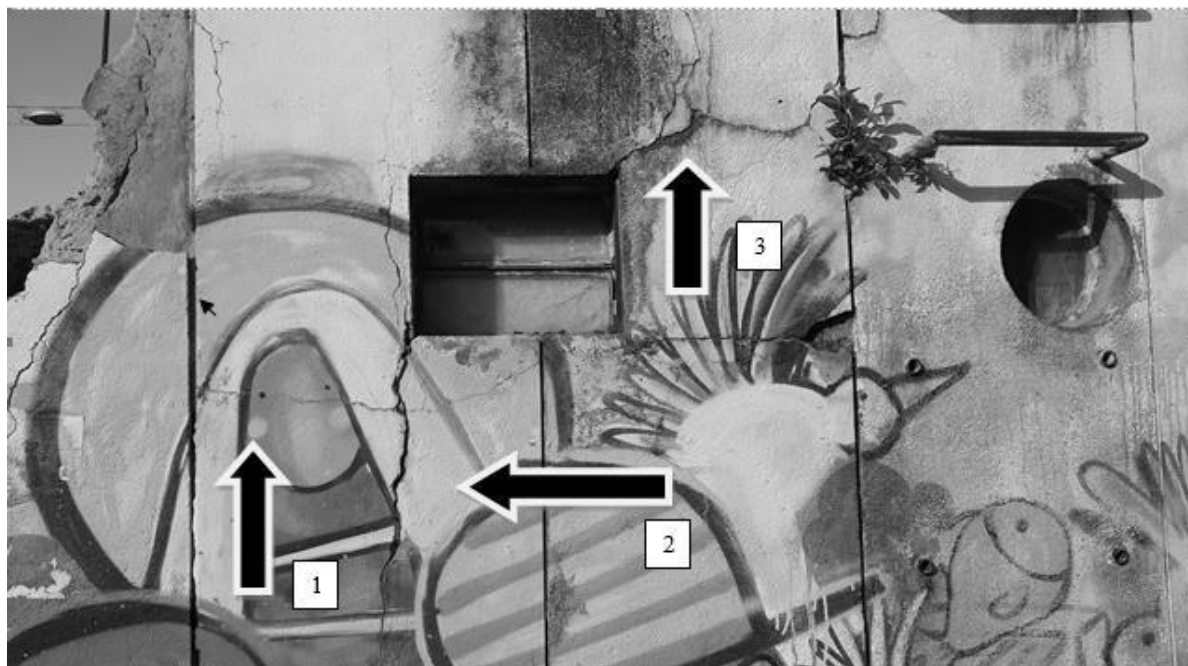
Patogias da parede da pista de skate (fonte do autor).
